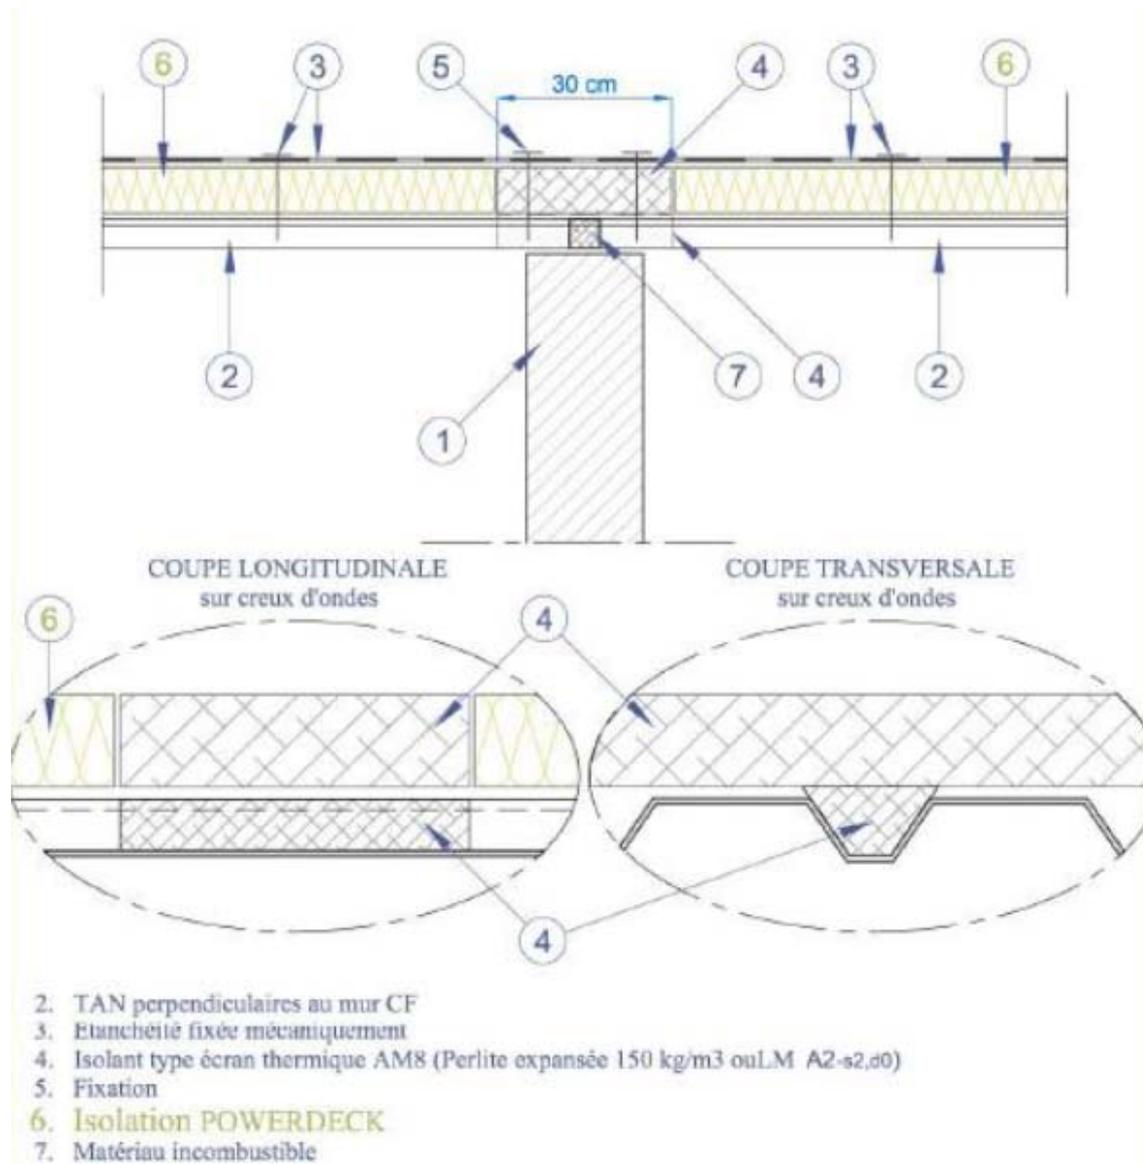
POWERDECK en ERP sans écran thermique : Exemple de recouvrement au droit d'un mur coupe-feu sous couverture sur TAN perpendiculaires au mur coupe-feu
